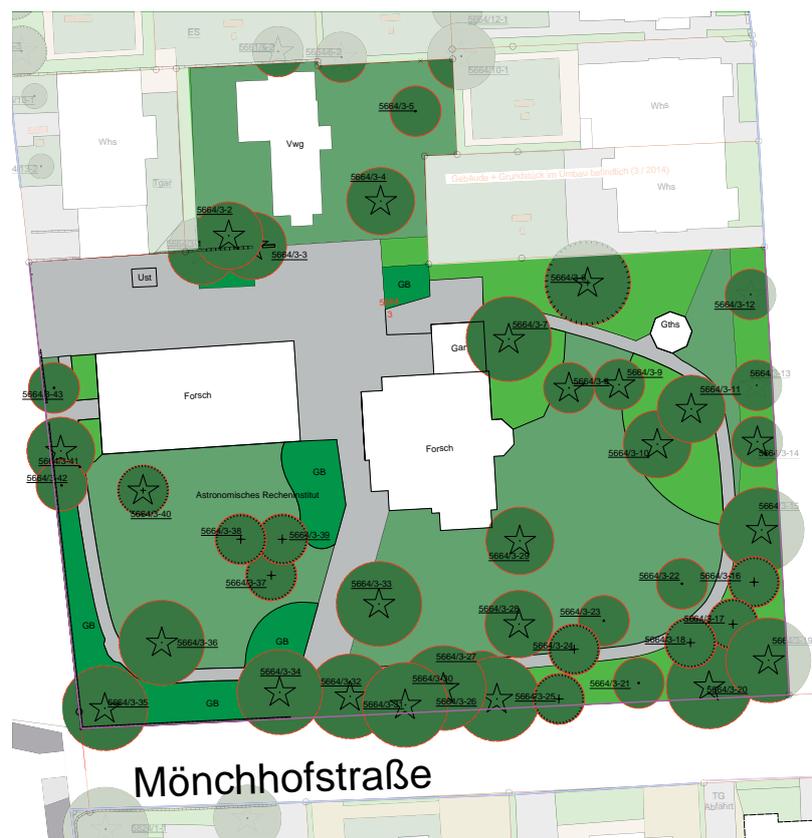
Lageplan o.M., Mönchhofstraße 12-15, o.M.
